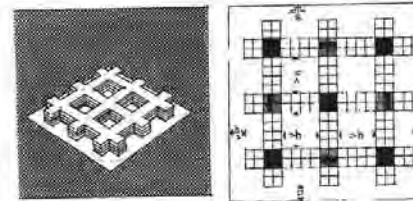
Photo und Schrägschnitt einer schalenartigen Bebauung im 40-m-Grundriss mit unterschiedlichen Baukörpern (Kreuzformen) (Darmstadt)
